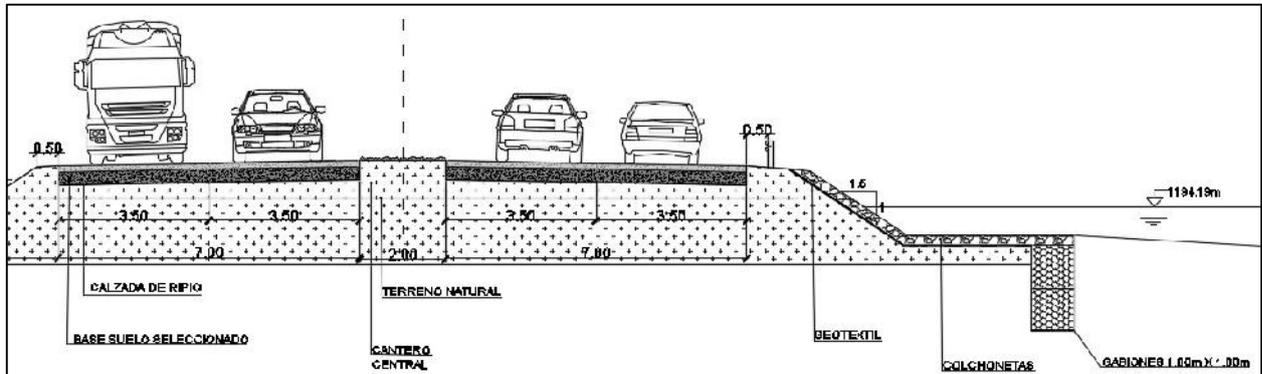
Perfil Tipo de Obra de Protección del Camino Costanero
